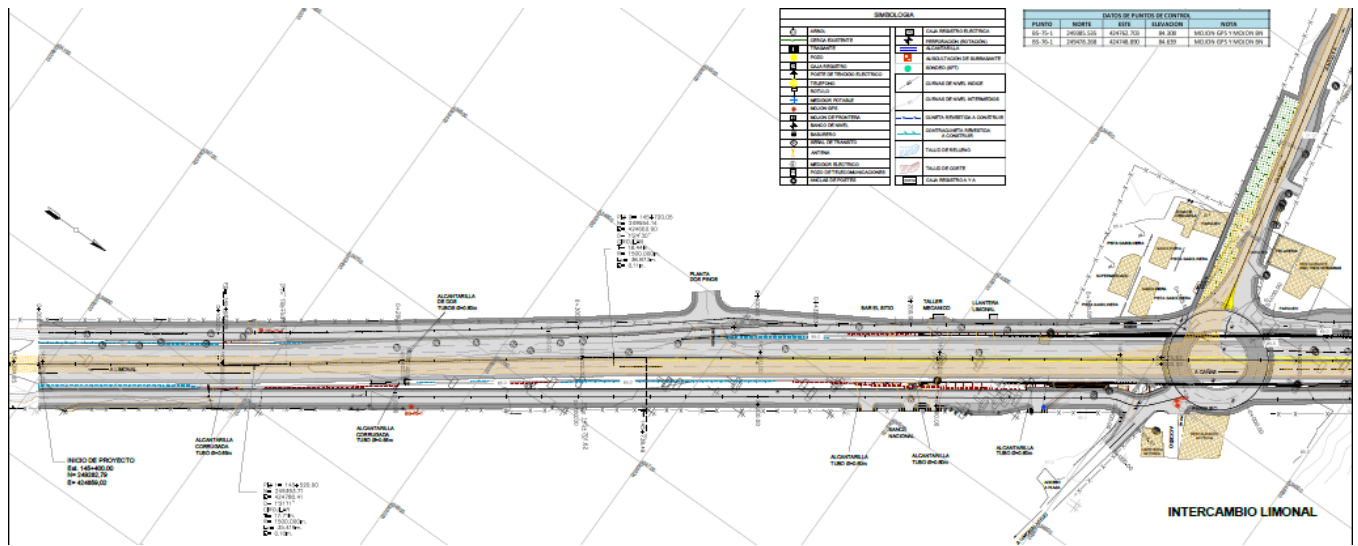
Planta de perfil (estación kilometraje 145+400-146+100)
